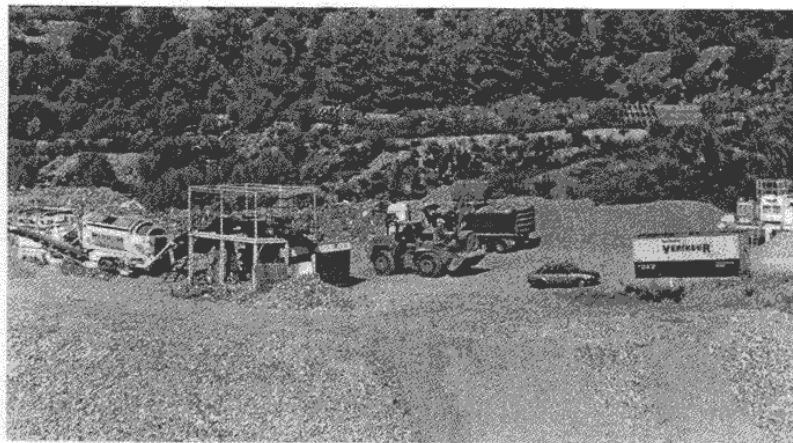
Vista parcial de la planta de Aresur en la provincia de Cádiz.
